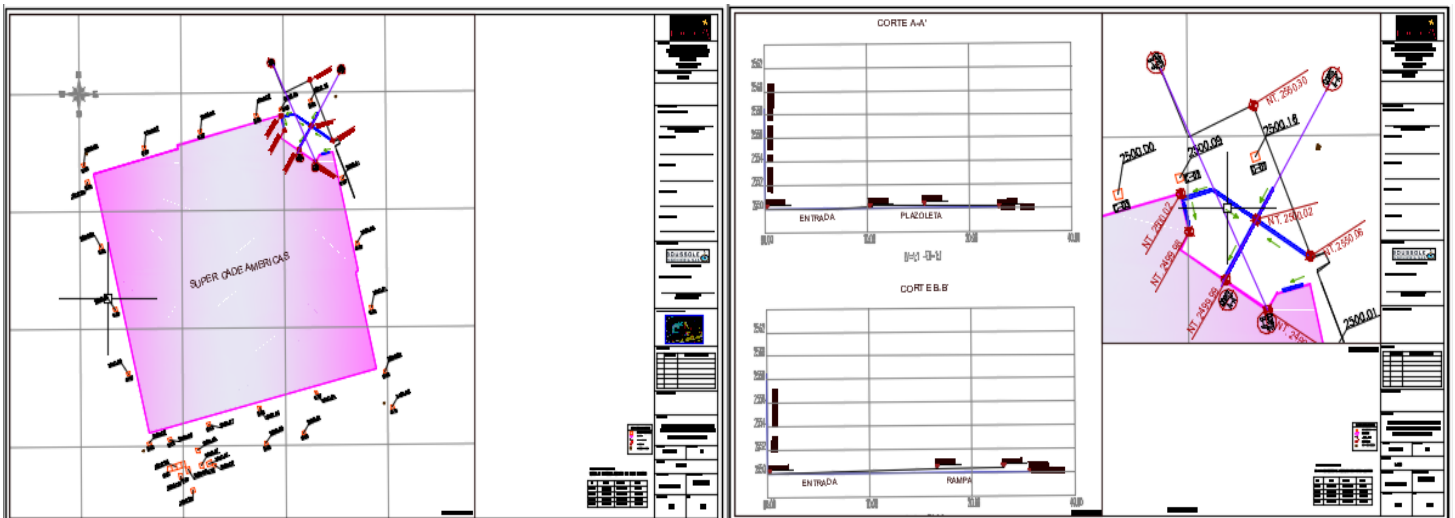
Plano levantamiento Topográfico Planta Perimetral y Cajas y perfil
